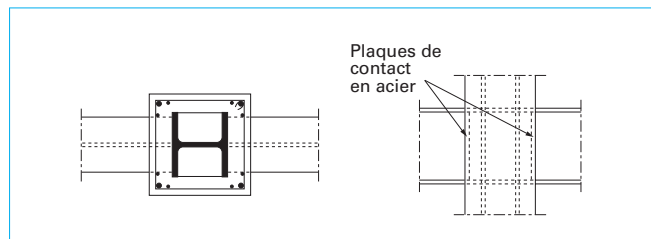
Assemblage d'un poteau mixte totalement enrobé de béton et d'une poutre en acier
